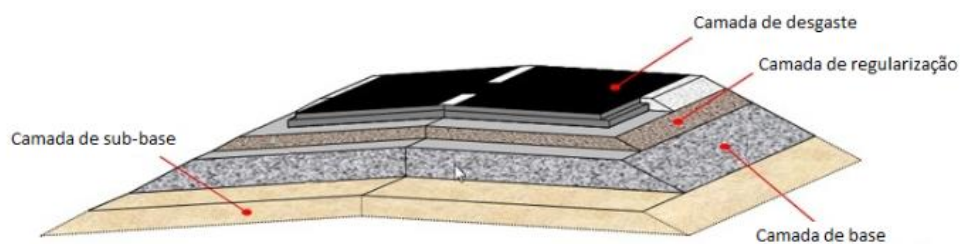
Constituição do pavimento flexível (fonte: Adaptado de Khan, 2016).
